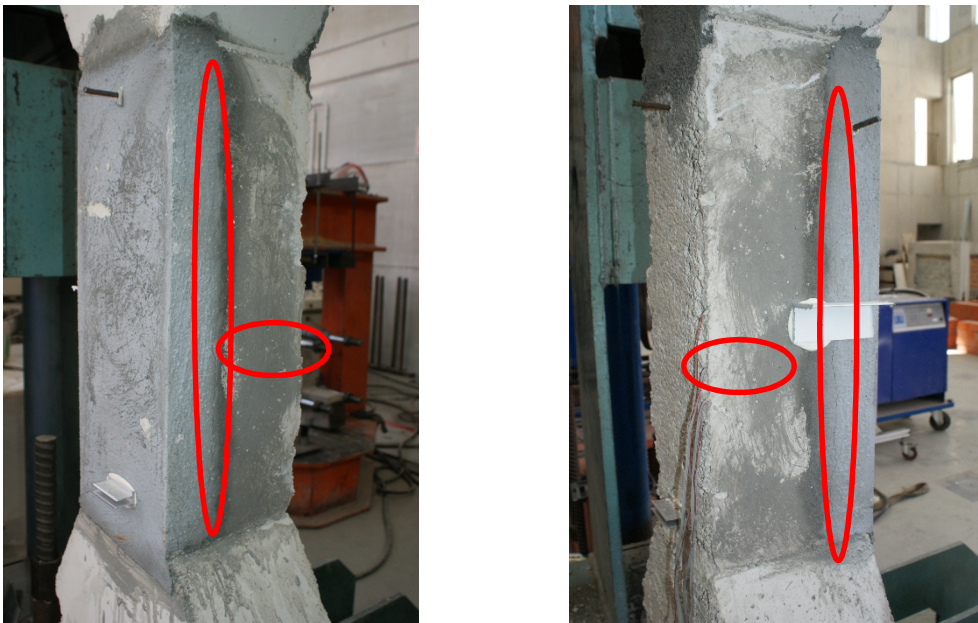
Pilares PR1C_R3+PU tras el ensayo a compresión. Fisuración caras laterales C2 y C4 respectivamente.
